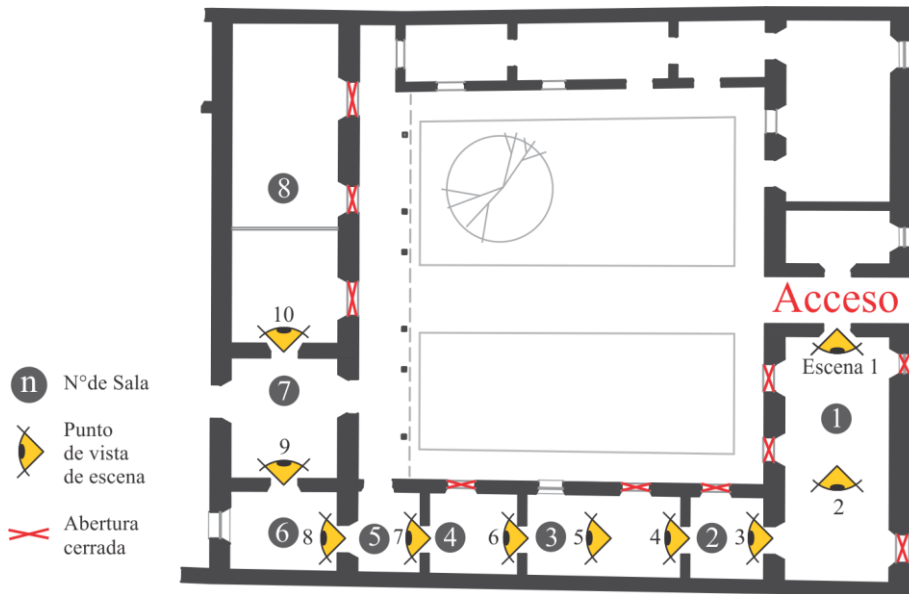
Planta del primer museo y puntos de vista de escenas por sala.
